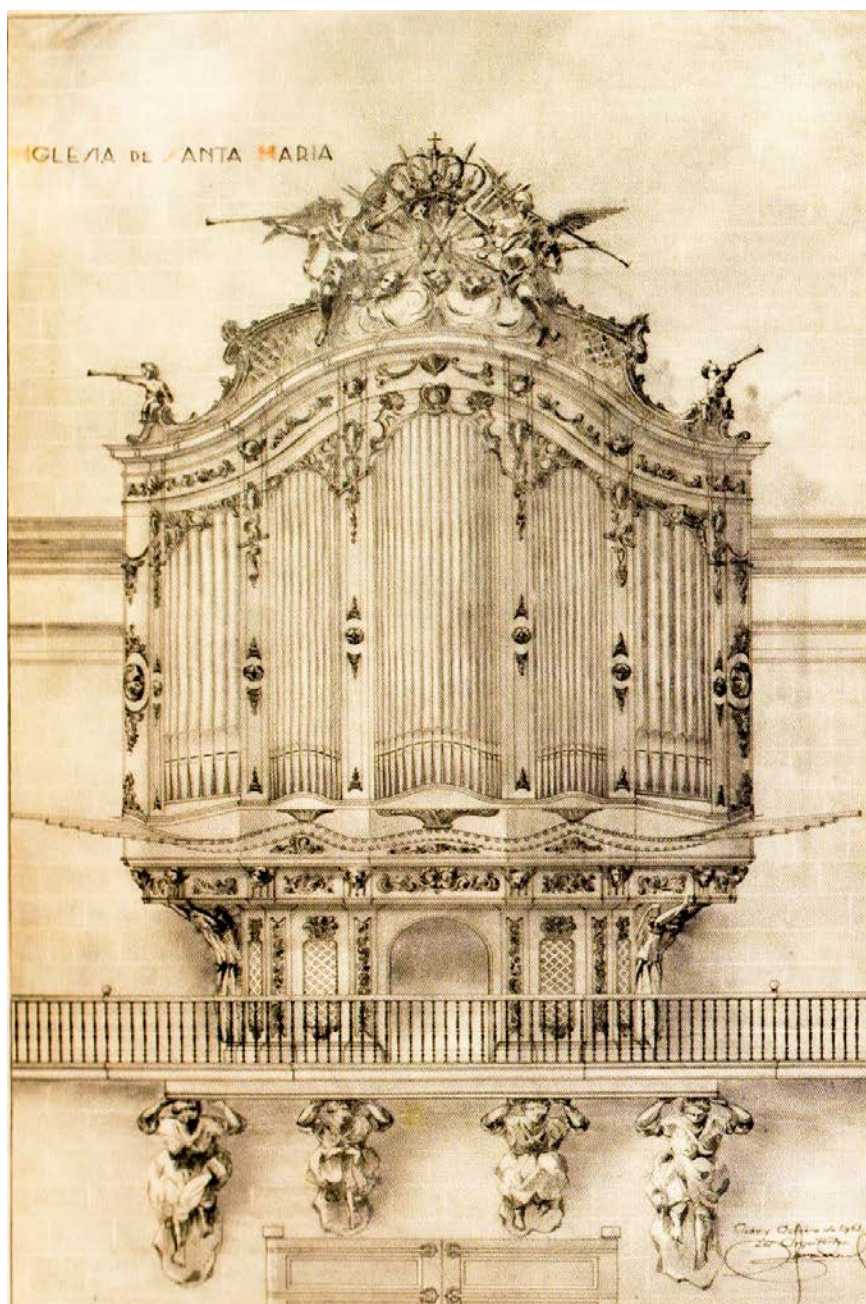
Plano de detalle del órgano. Proyecto de Restauración de la Iglesia de Santa María de Elche de Antonio Serrano en 1940 (Ajuntament d'Elx, 2010).
